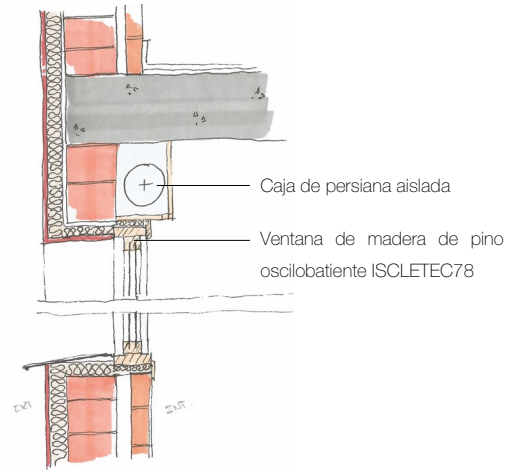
Detalle constructivo del hueco de ventana con caja de persiana y con el sistema SATE de aislamiento aplicado en fachada (autoría propia).
